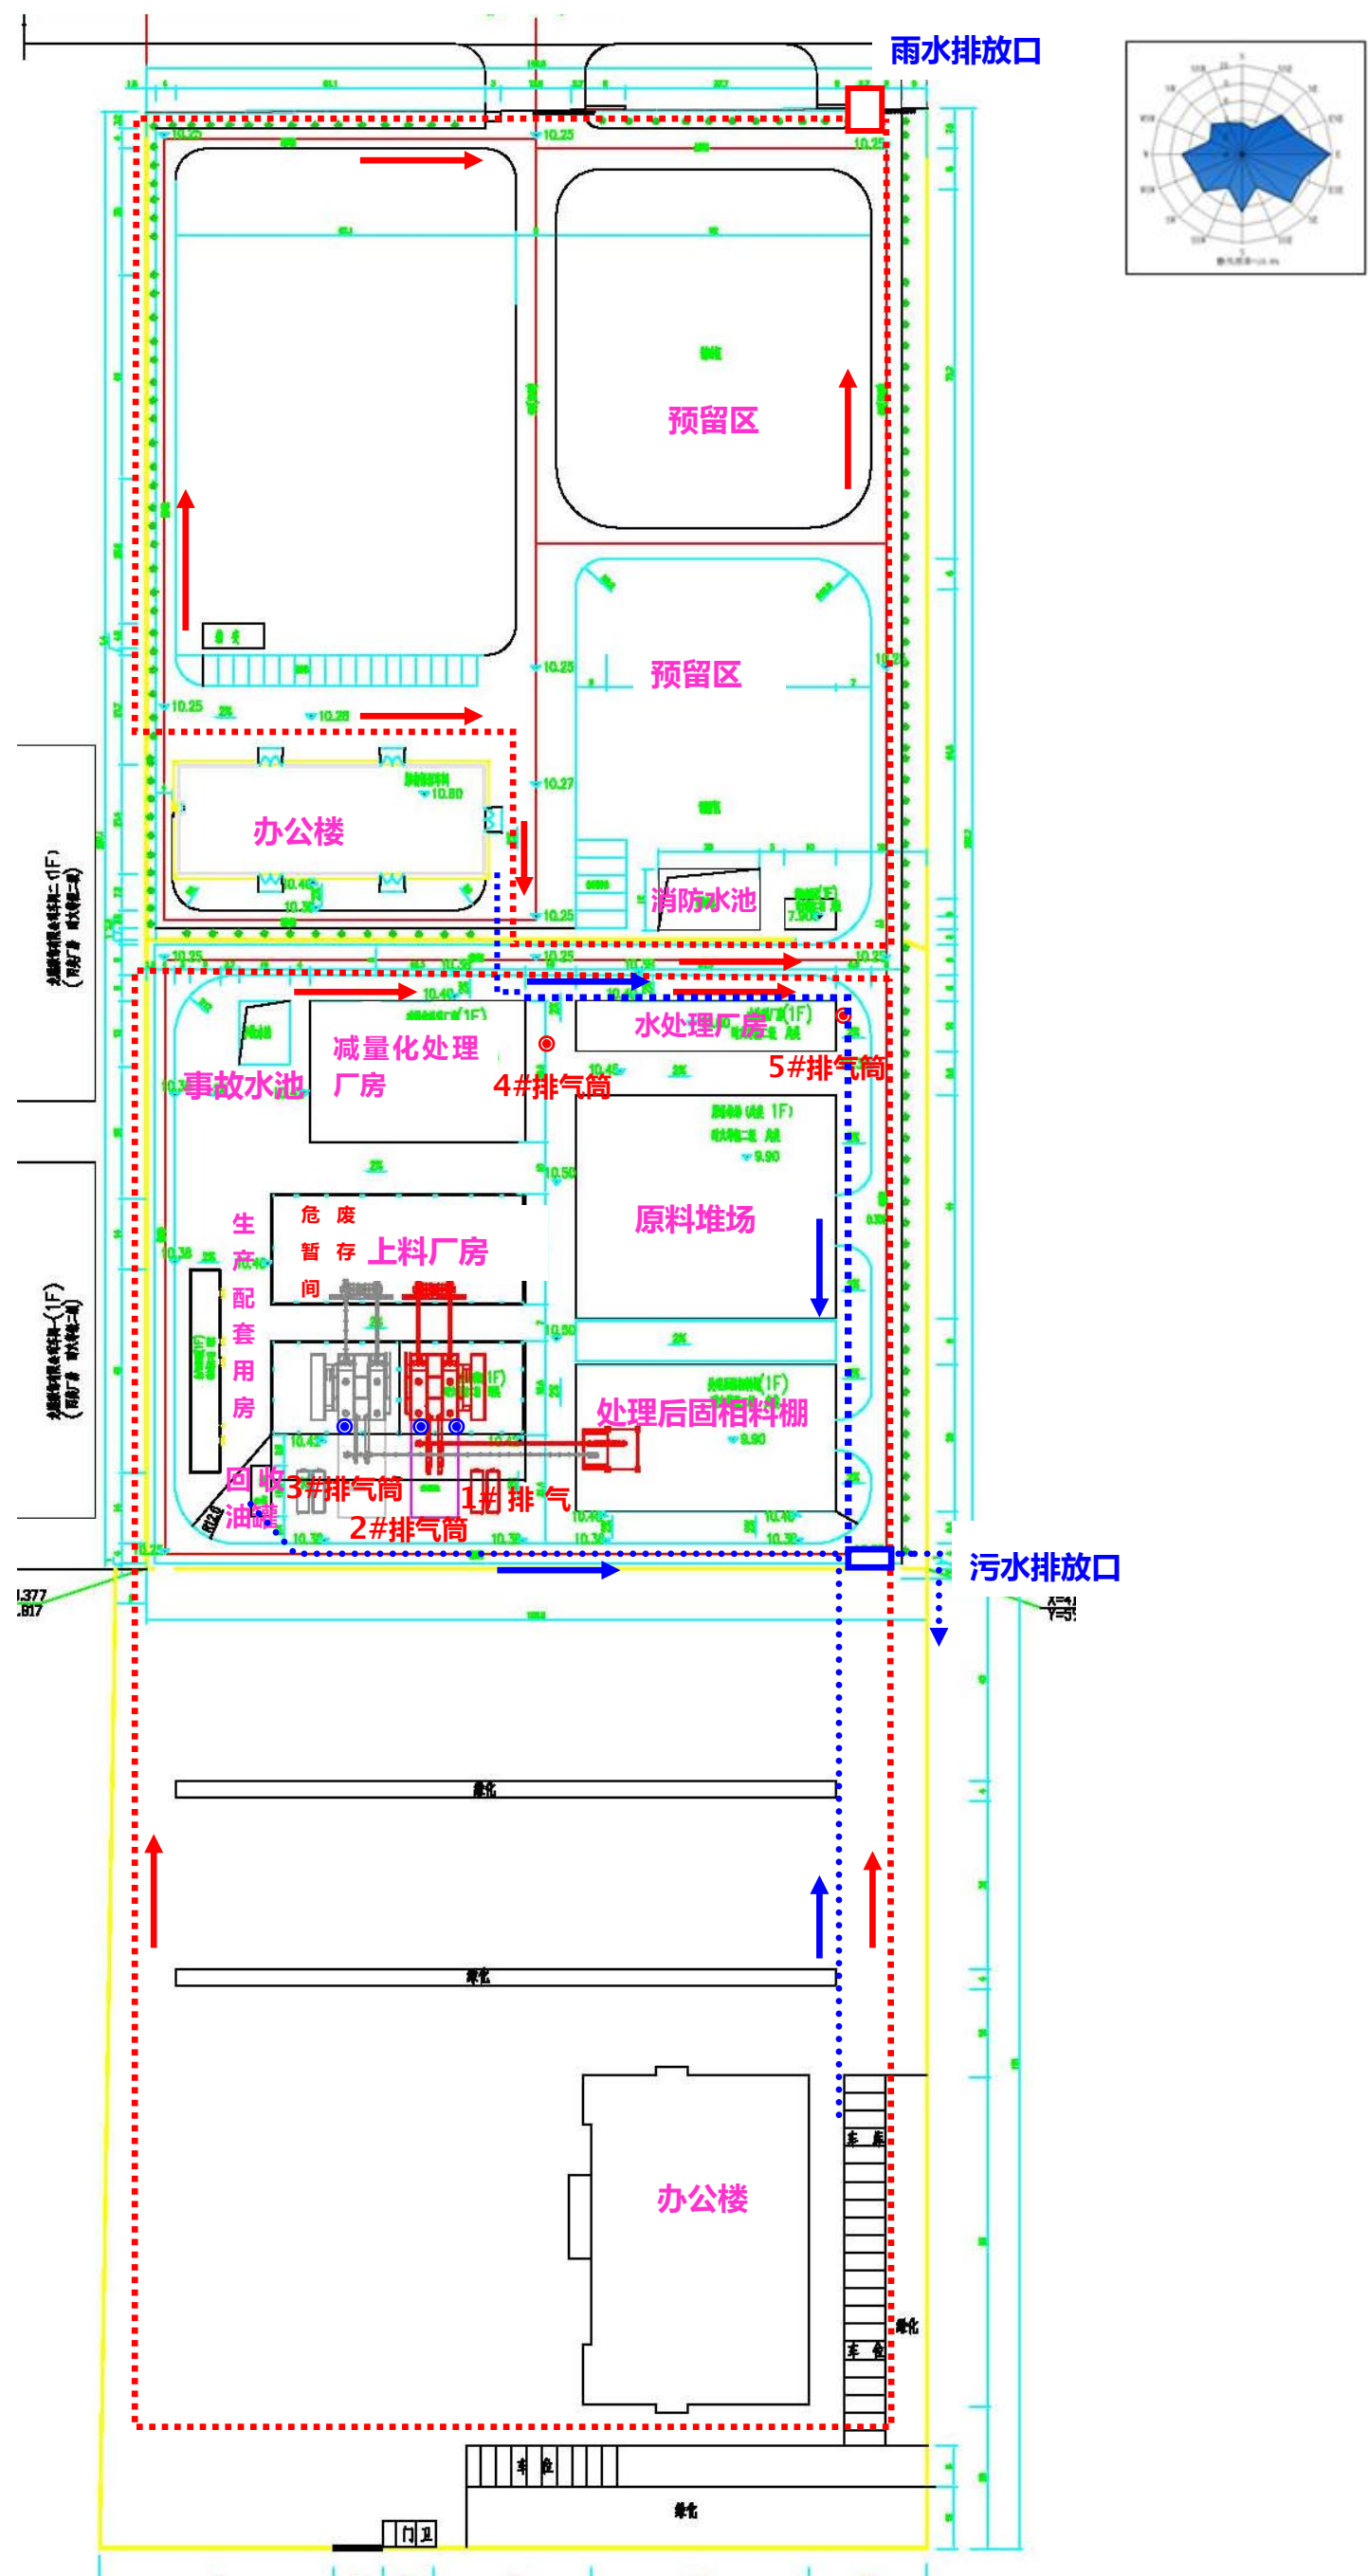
项目实际平面布置图 (比例尺 1:500)
